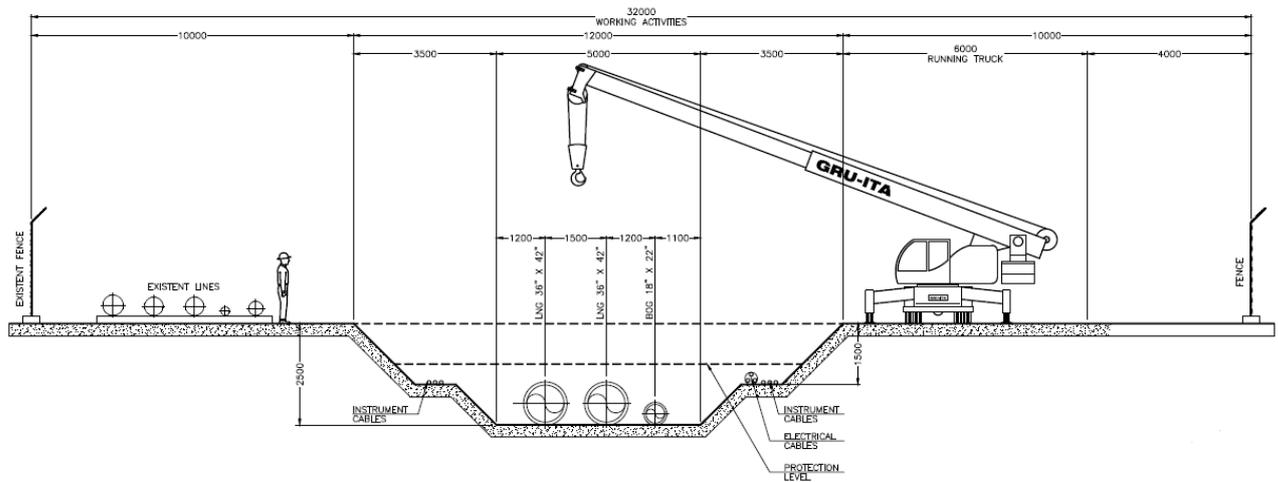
Sezione Tipo della Pista per la Posa delle Condotte
